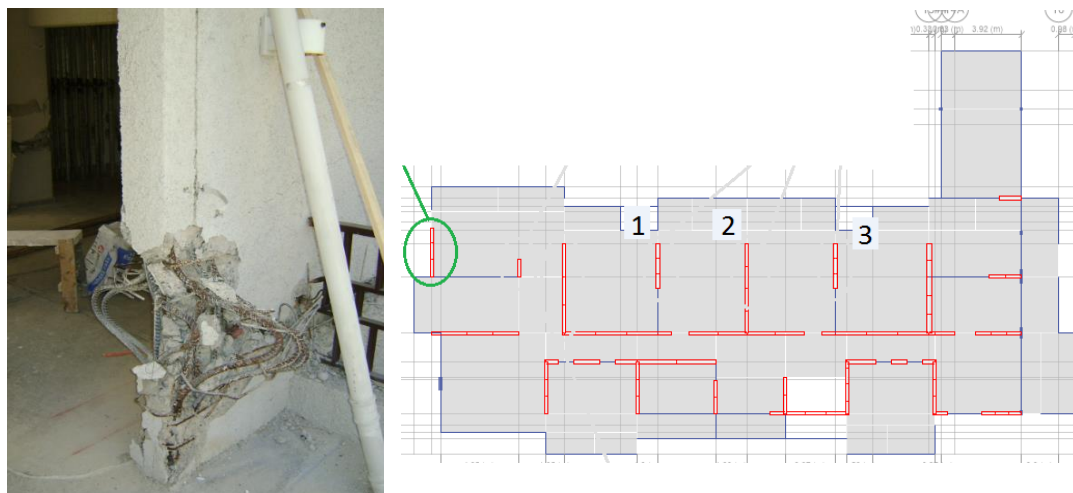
Imagen del daño y ubicación en planta del elemento T13-1
